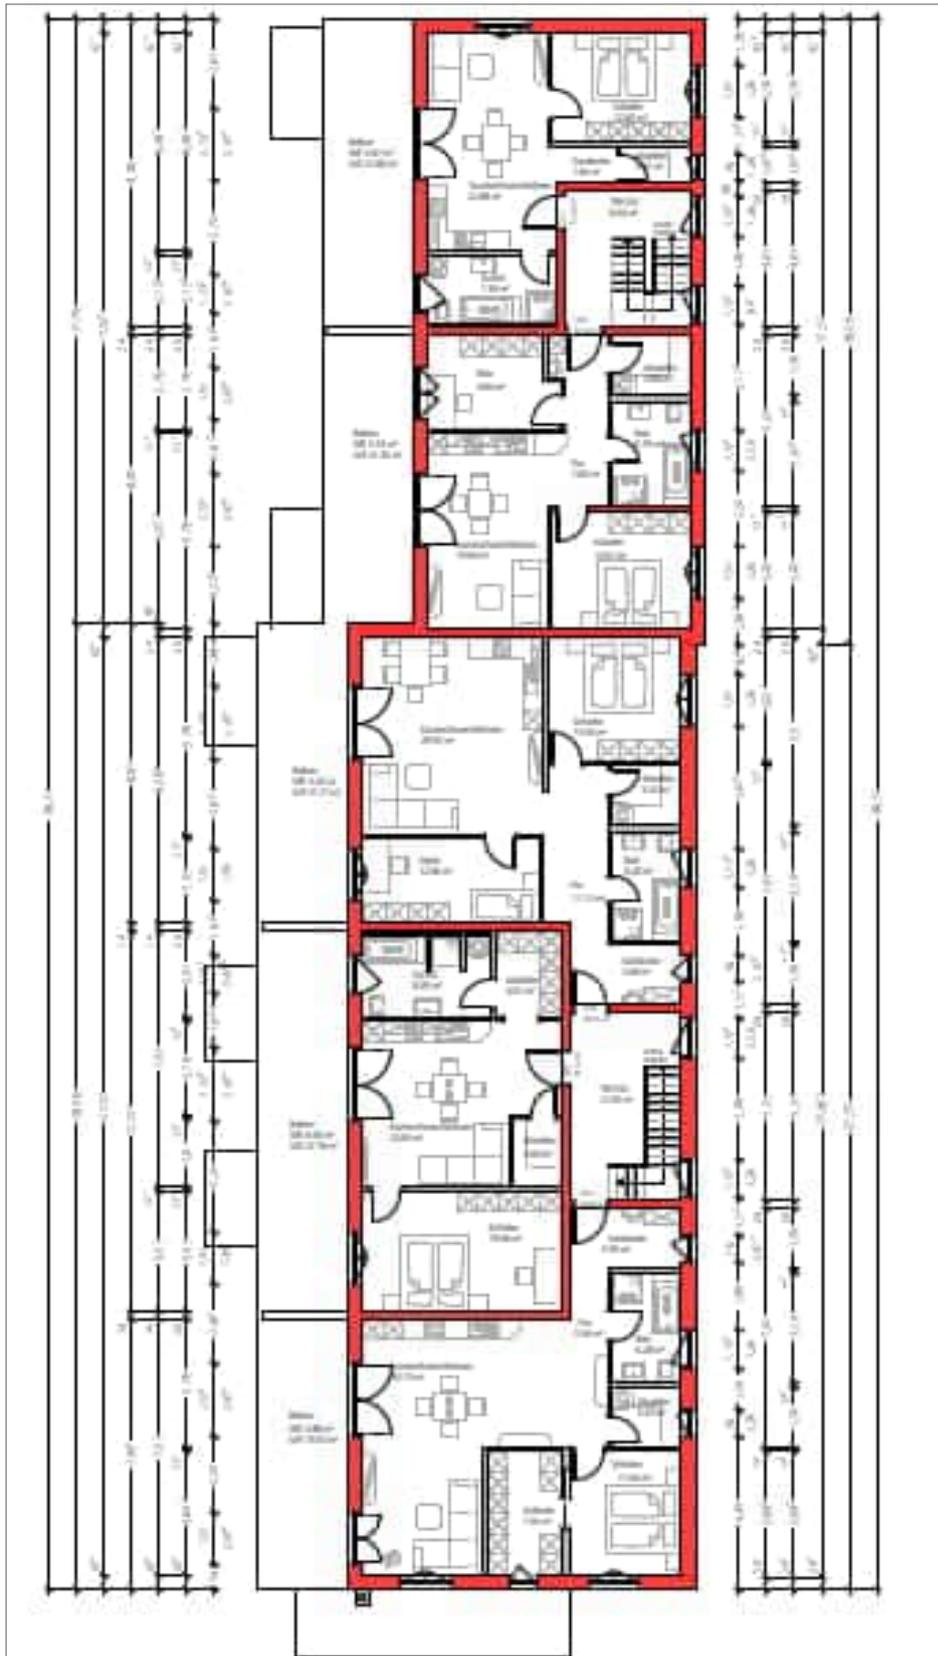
geplanter Grundriss im 2.OG/DG "MFH Rössle" (Verfasser: IB Leis, Reichling)
